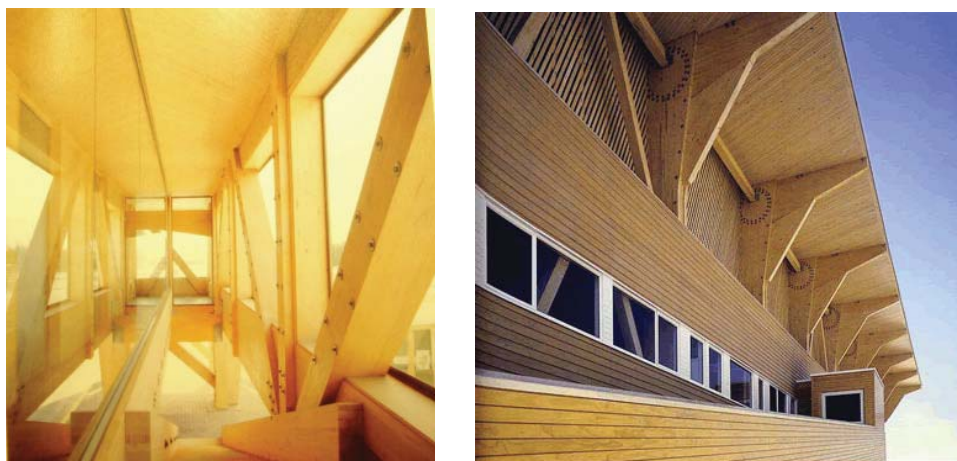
y 145. Detalles del uso de la madera laminada en vigas y pilares. Hacia una nueva abstracción, José cruz Ovalle.
